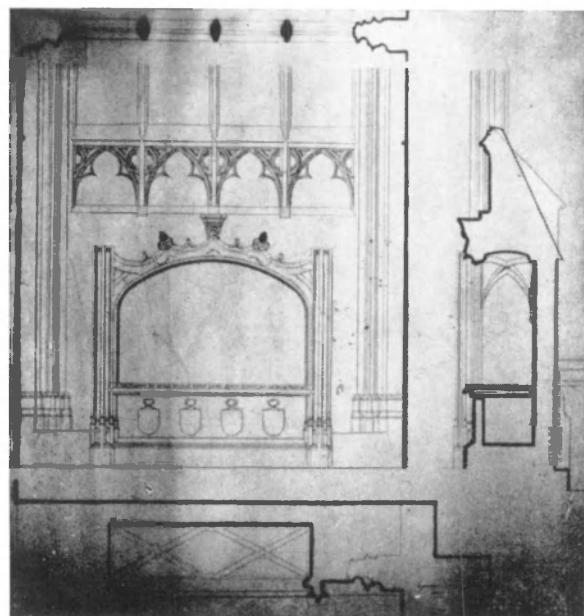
Plan, coupe et élévation du tombeau de Philippe Keerman. Archives de l'église, plan n° 24.
